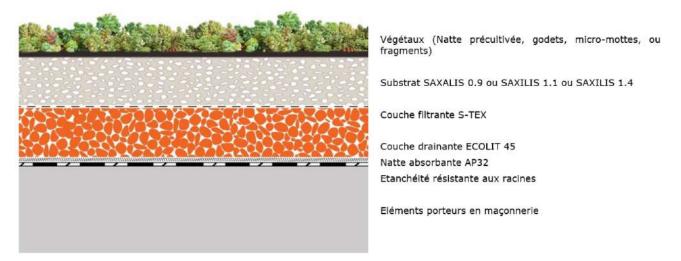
Principe des systèmes de végétalisation ECOVEGETAL sur étanchéité avec couche drainante ECOLIT 6/25 pente < 3%
